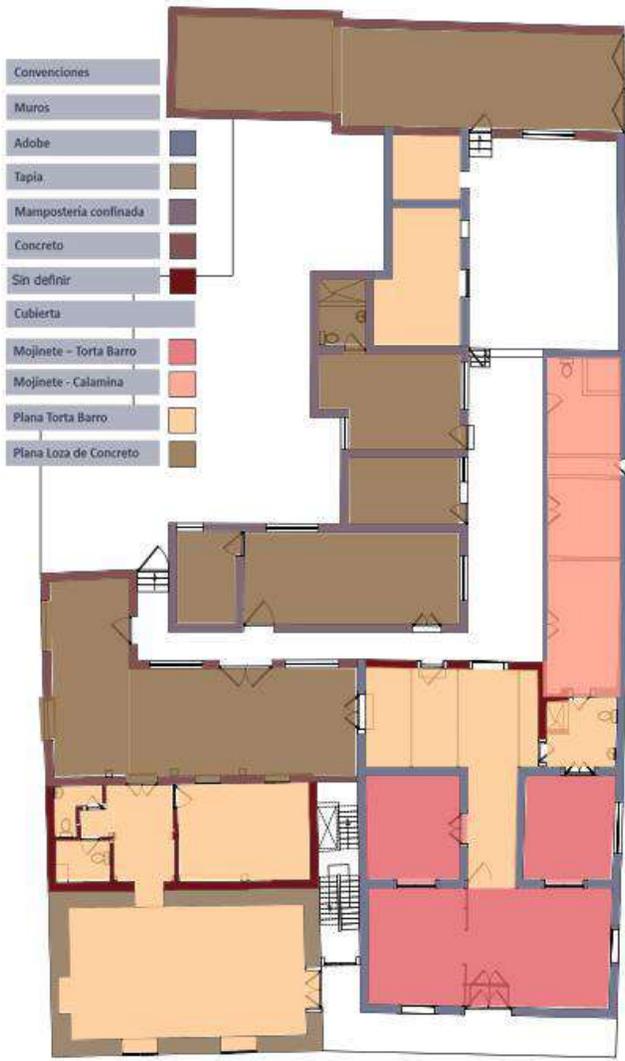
Sistemas Constructivos Primer Nivel Fuente: Elaboración Efran Ventura
